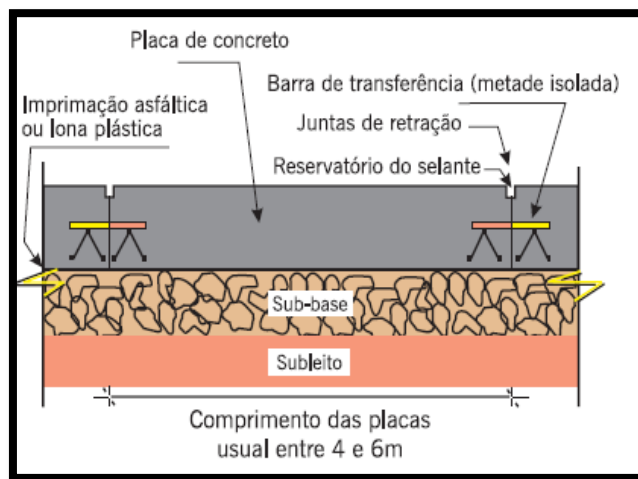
Corte de pavimento rígido. Fonte: Bernucci, 2006.
